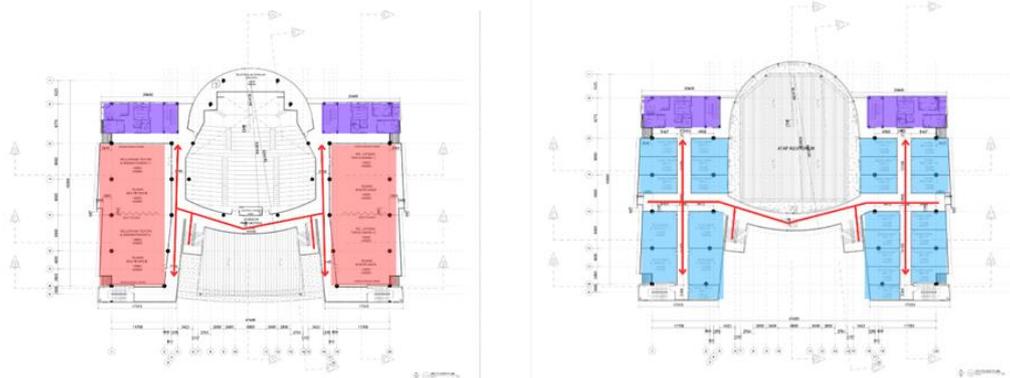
Denah Lantai 1 (Kiri) & Lantai 2 (Kanan)
